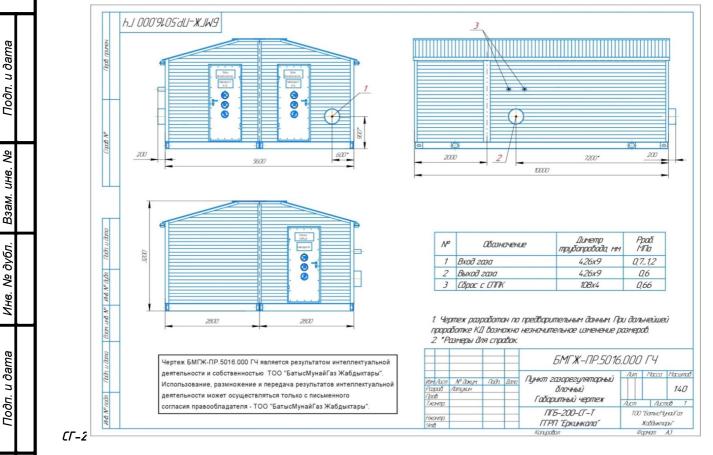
Габаритный чертеж ГГРП-«Коксай» марки ГРПБ-РДГ-80В/РДГ-80Н-2/2-1-A-10000-Т-СГ-2
